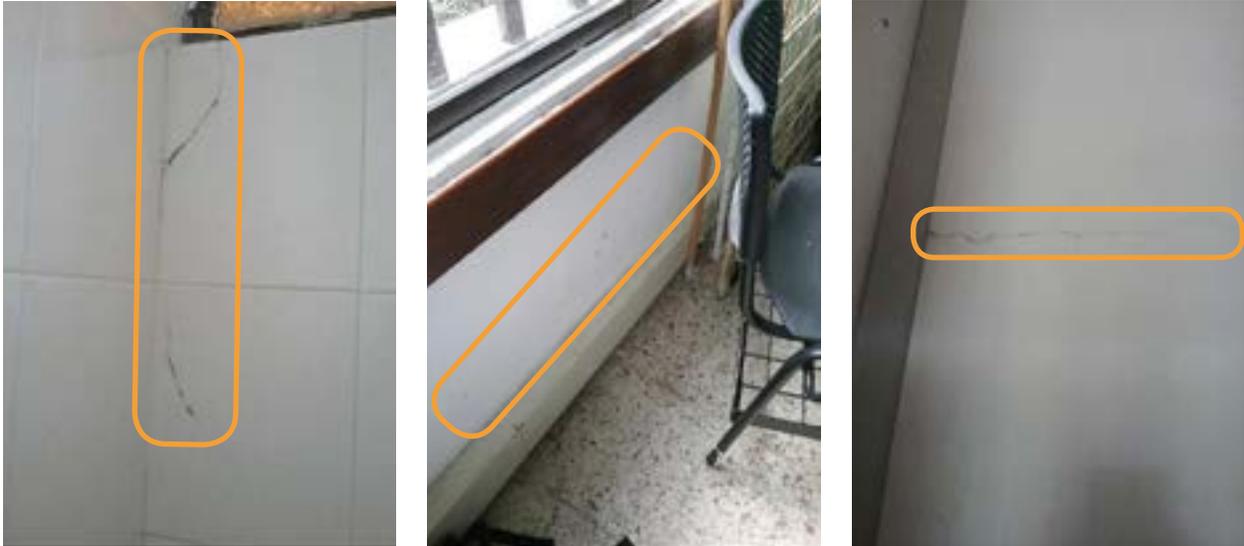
Fisuras y humedad en elementos no estructurales (muros de mampostería)
